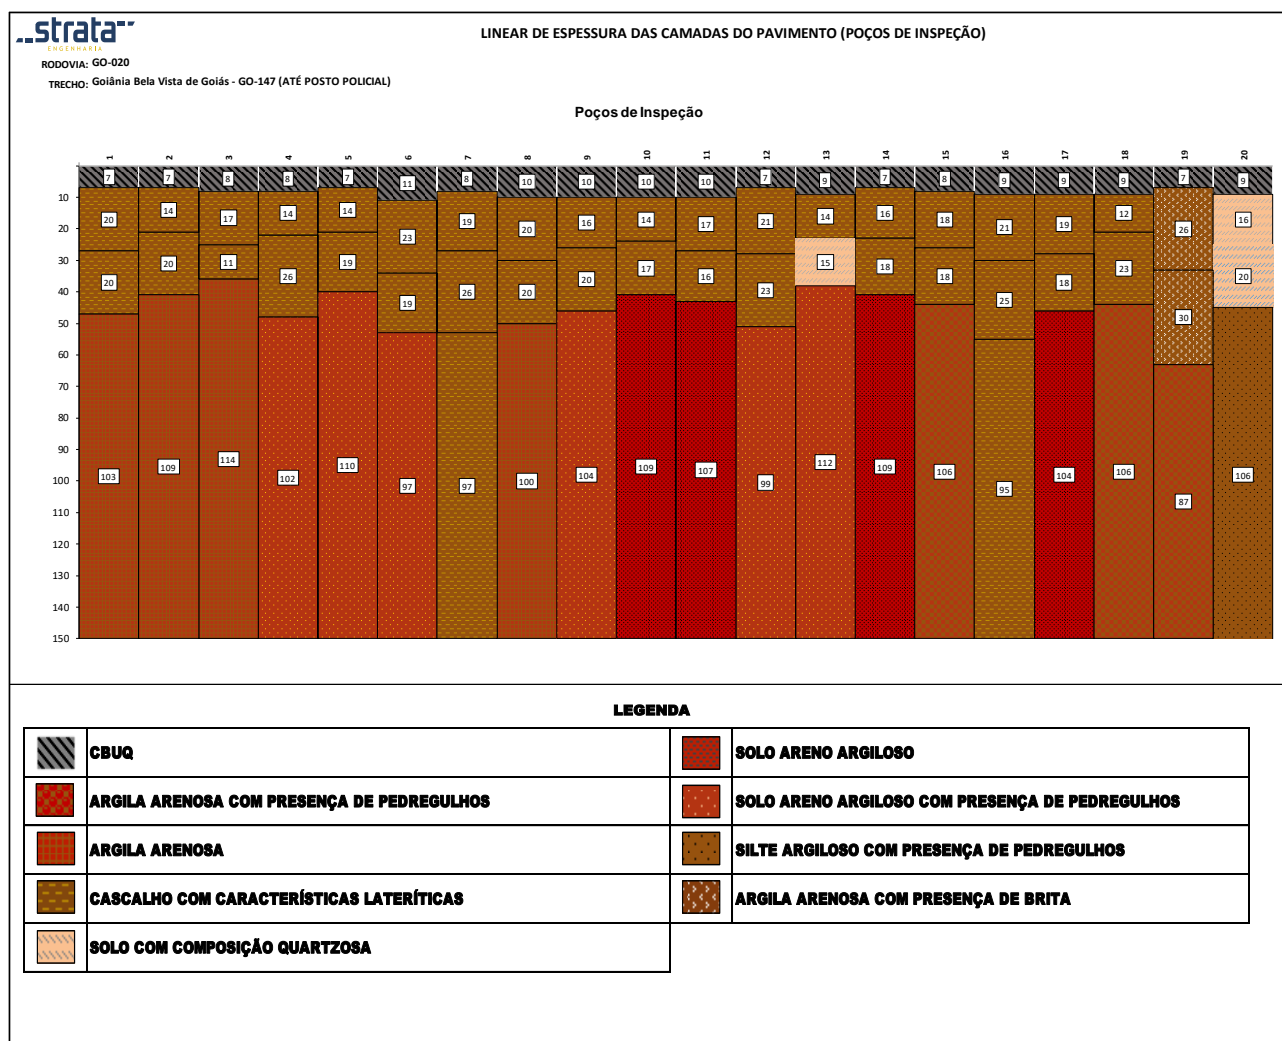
Linear de espessura das camadas do pavimento (PI-01 ao PI-20 lado esquerdo).
